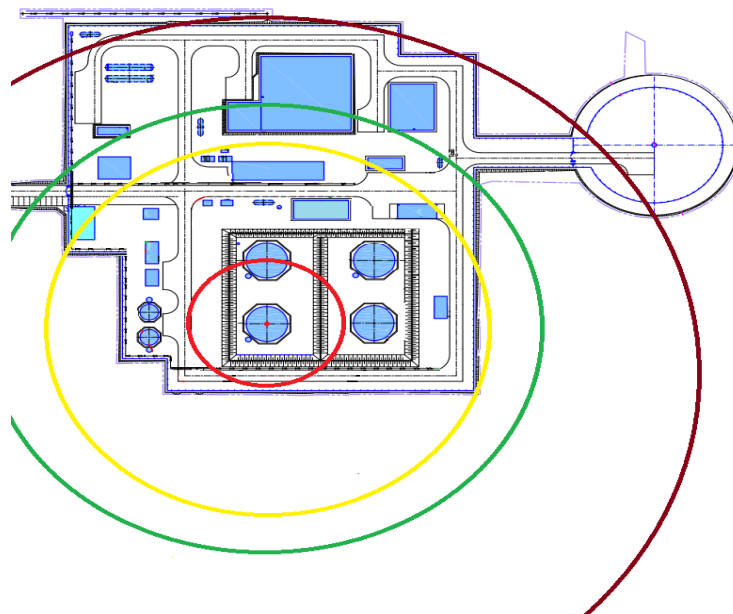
Распределение зон разрушения на предприятии: красный круг - зона полных разрушений; желтый круг – зона сильных разрушений; зеленый круг – зона средних повреждений; бардовый круг – зона слабых повреждений.
